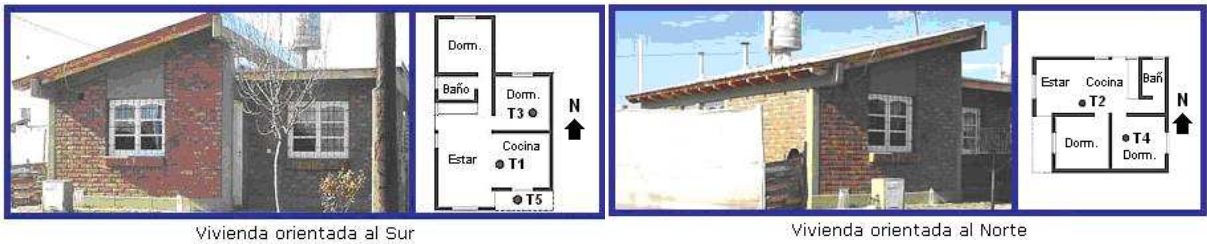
Fotos de las dos viviendas y vistas en planta con la ubicación de los sensores
